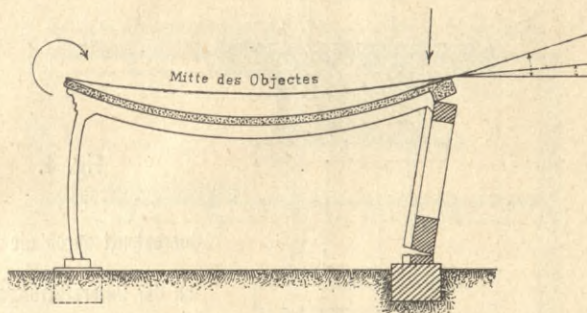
Das „hohe“ Object unter der halben Bruchlast.
